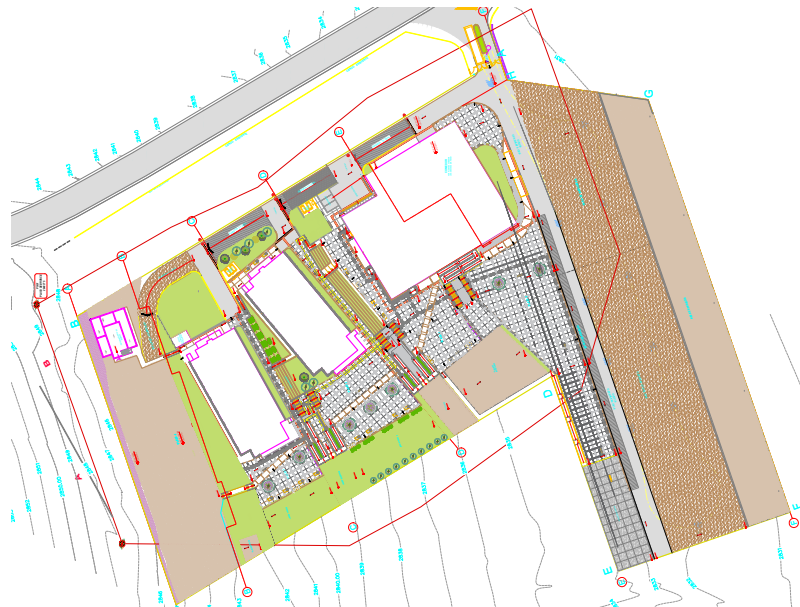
Vista en Planta del proyecto de la Villa Bolivariana- Campus UNSCH.
